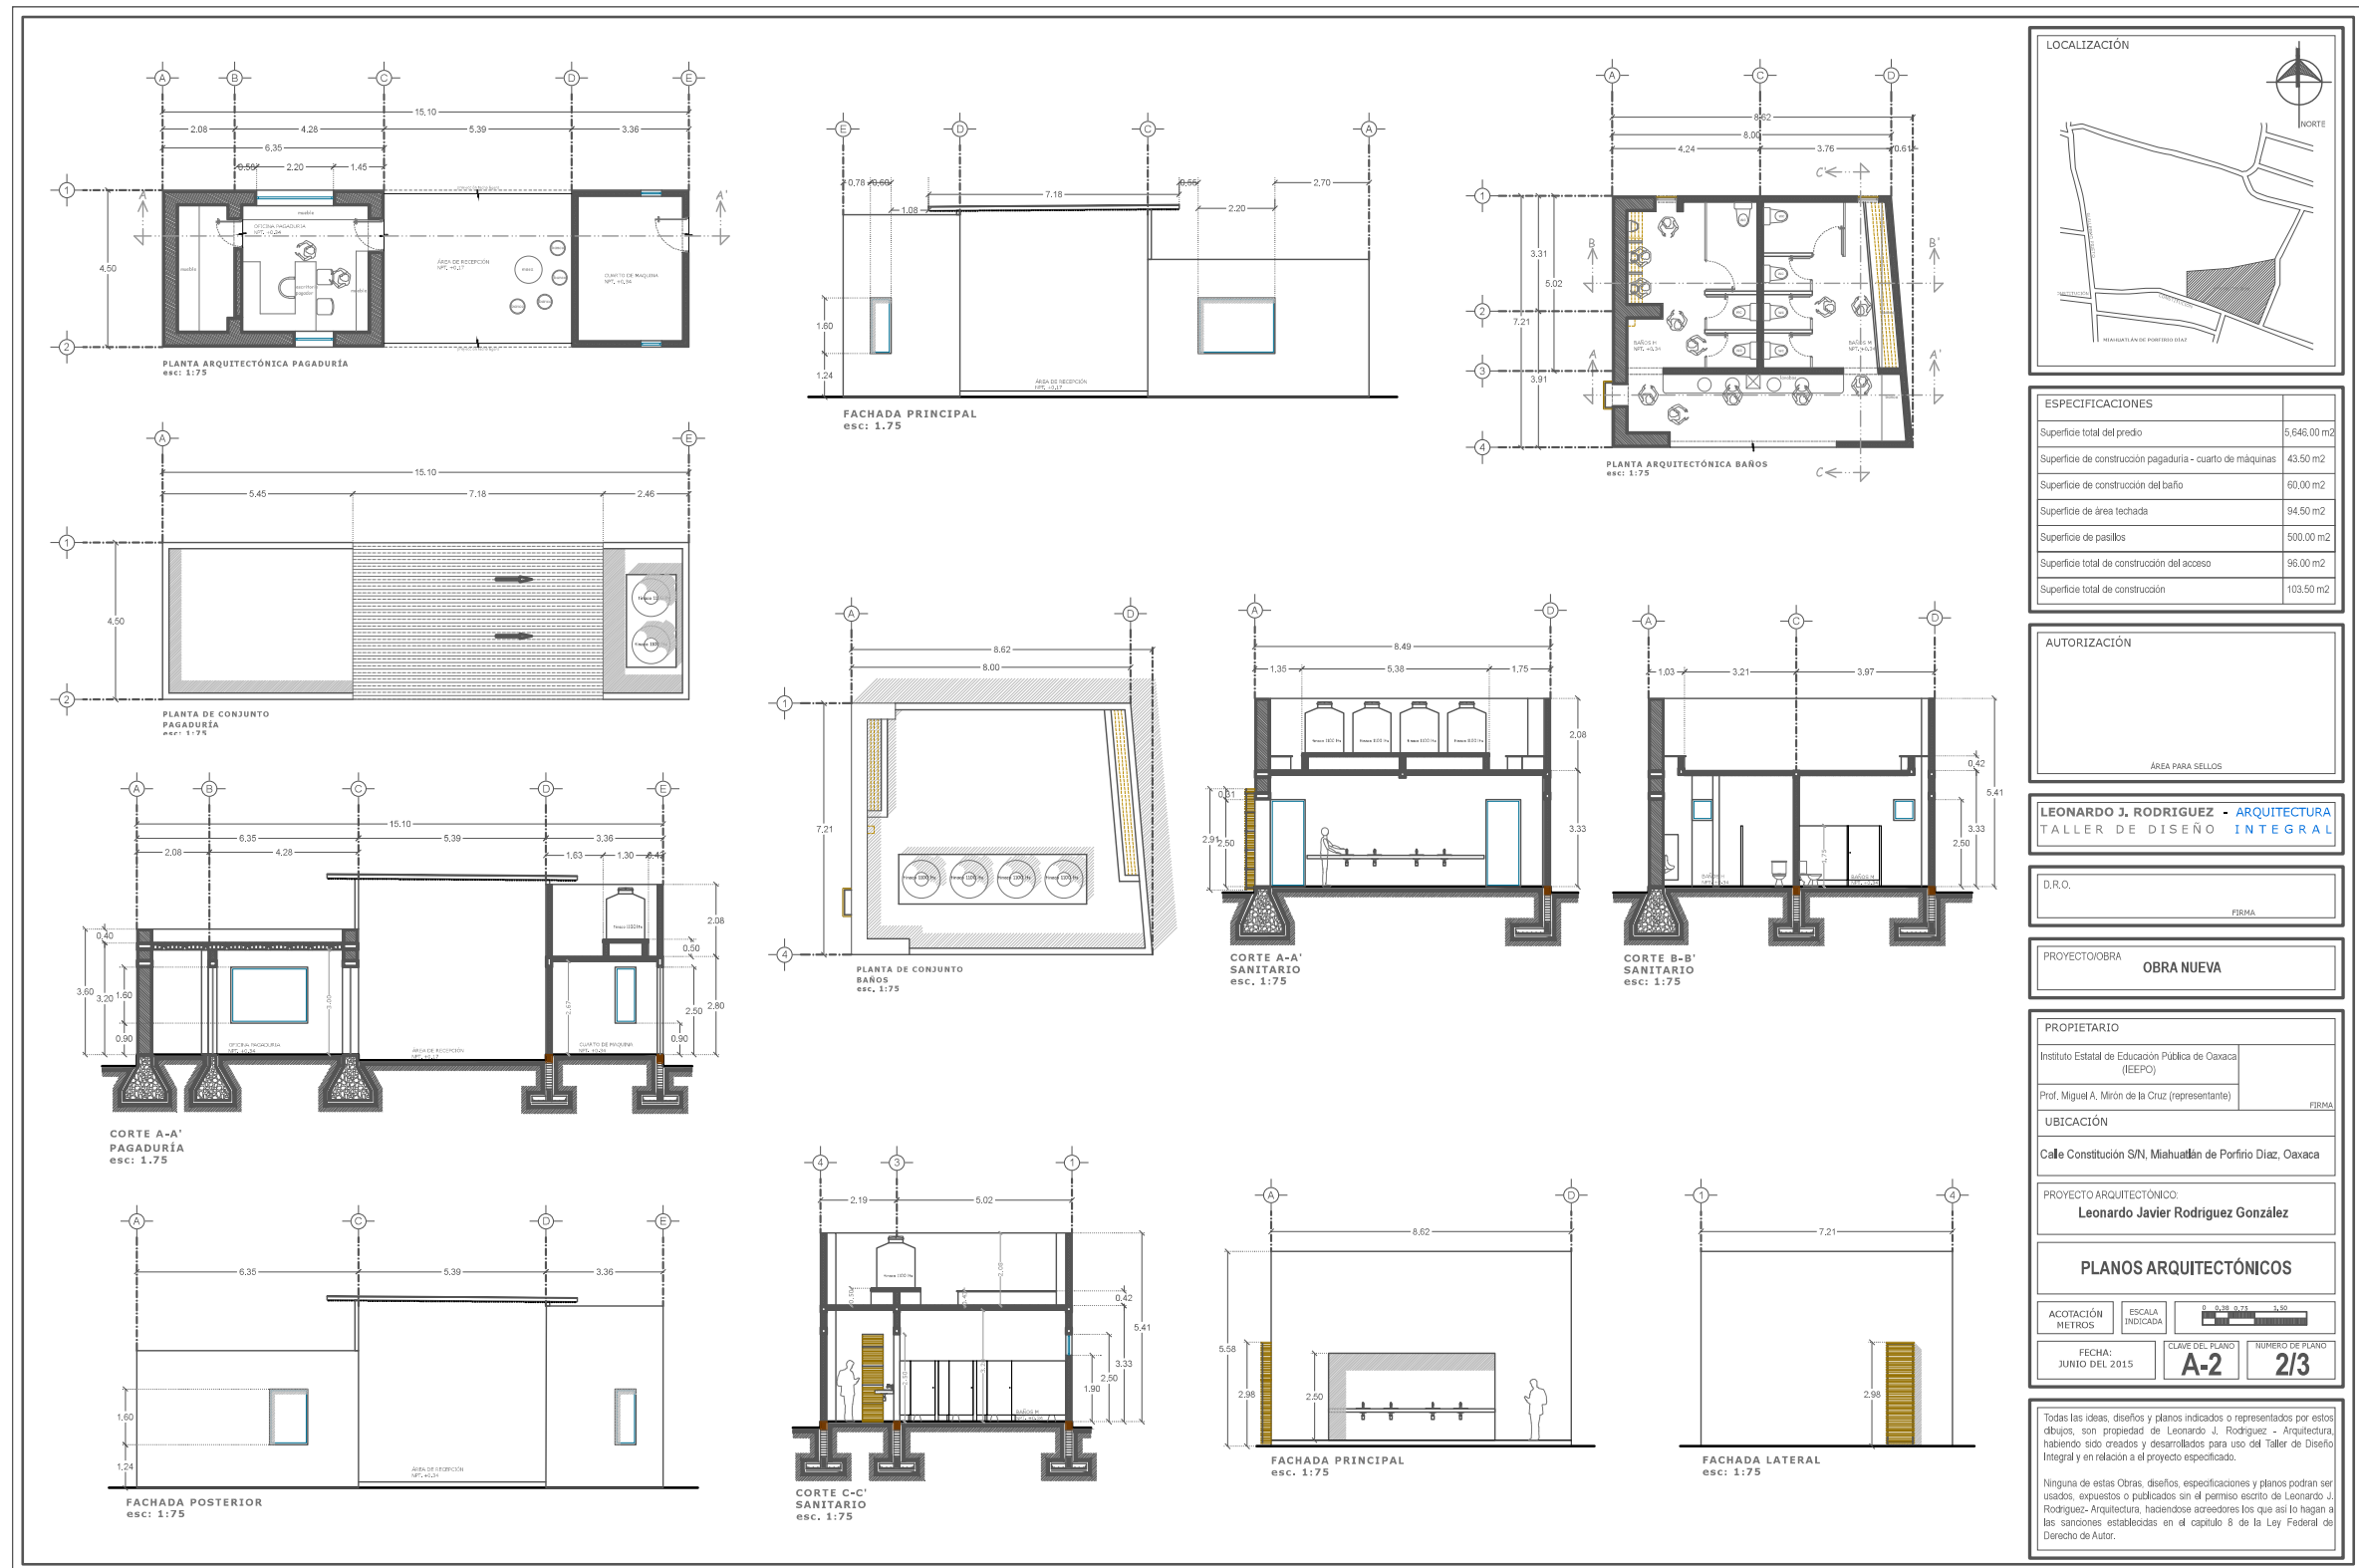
Plano arquitectónico ejecutivo de la pagaduría y núcleo sanitario, proyecto IESE
